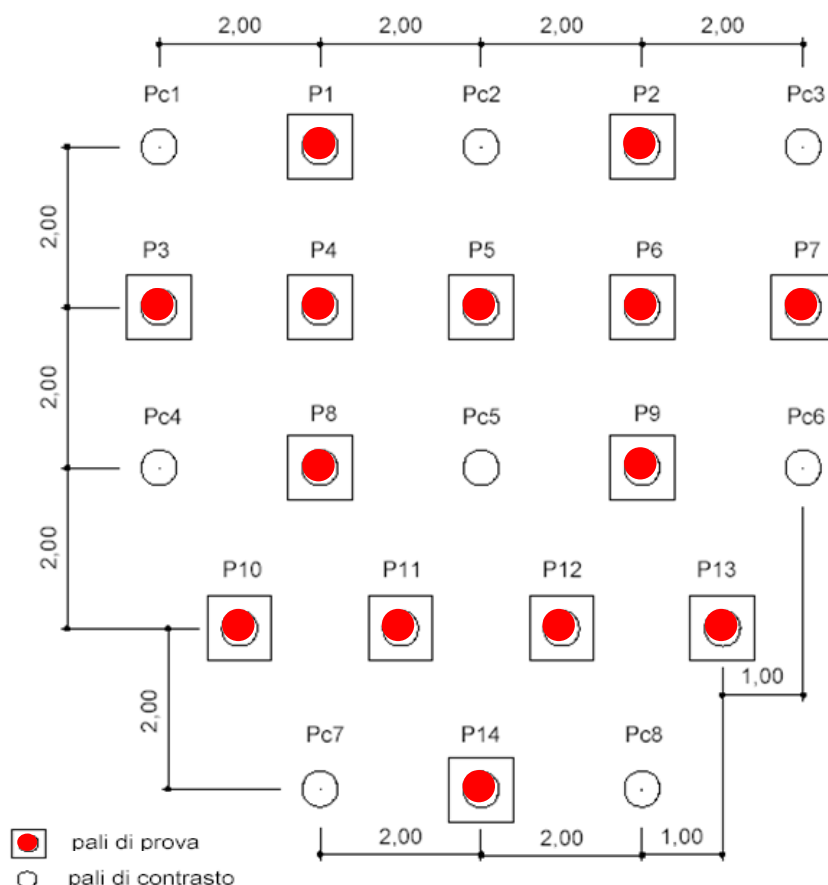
Disposizione planimetrica micropali testati nel campo sperimentale di S. Giovanni a Teduccio.
